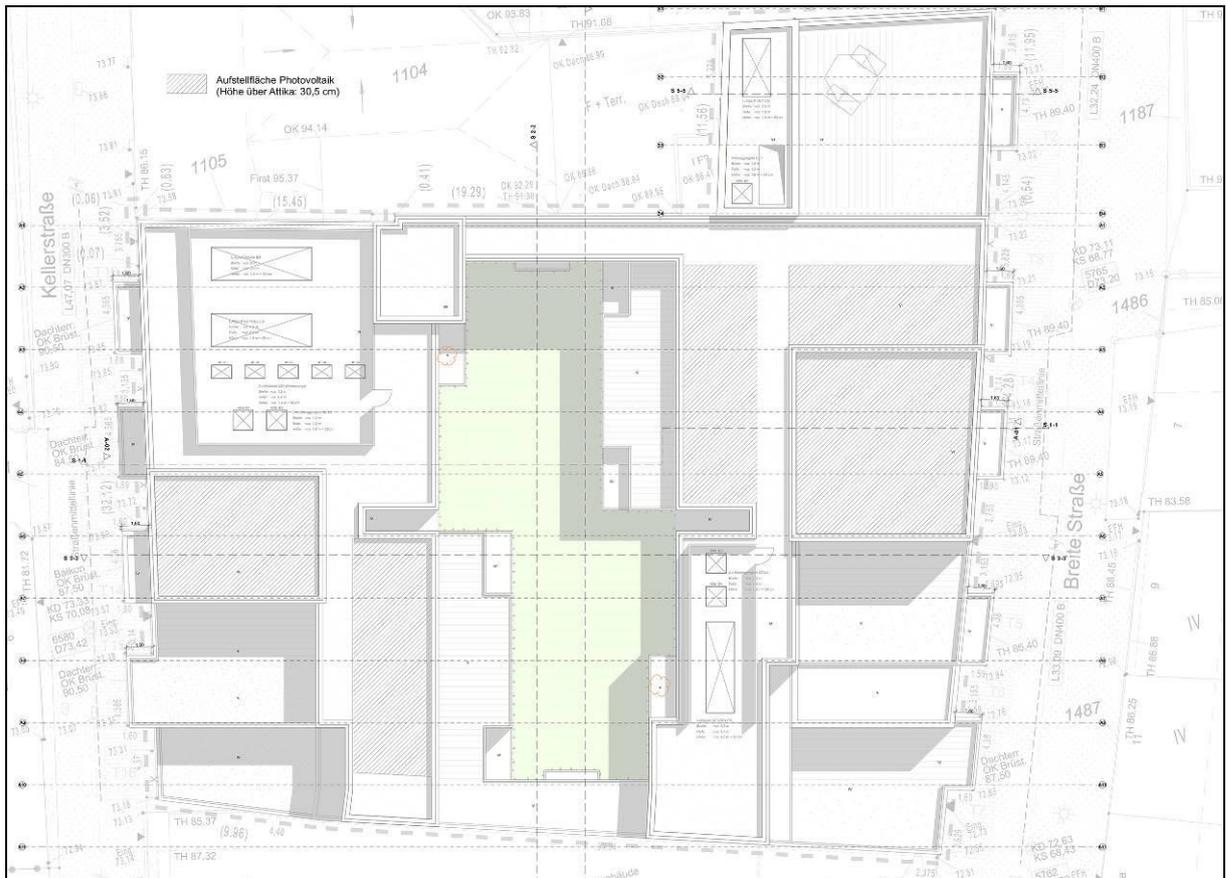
Dachaufsicht des geplanten Gebäudekörpers (Steinke + Zils Architekten)
